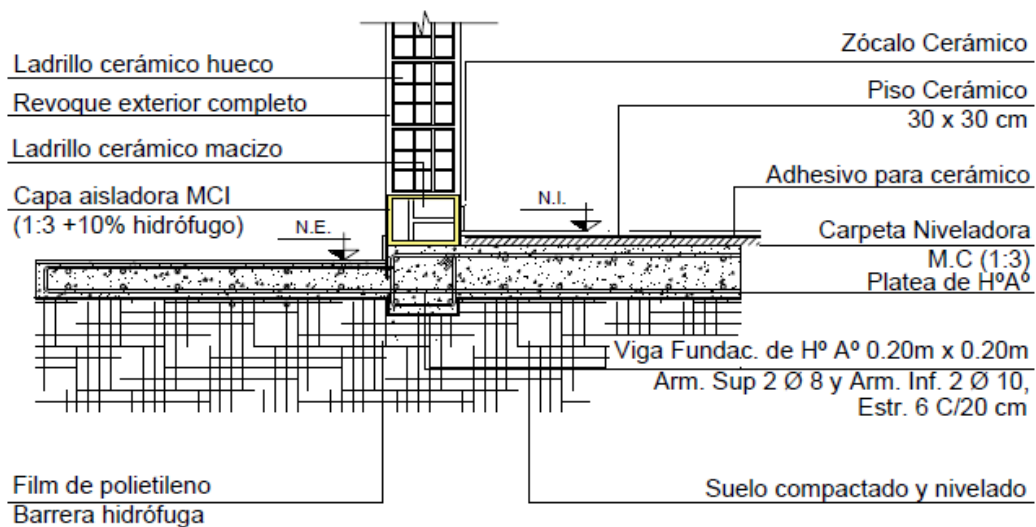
Detalle encuentro platea con muro de ladrillo hueco. (Fuente: Elaboración propia). Sin escala.
